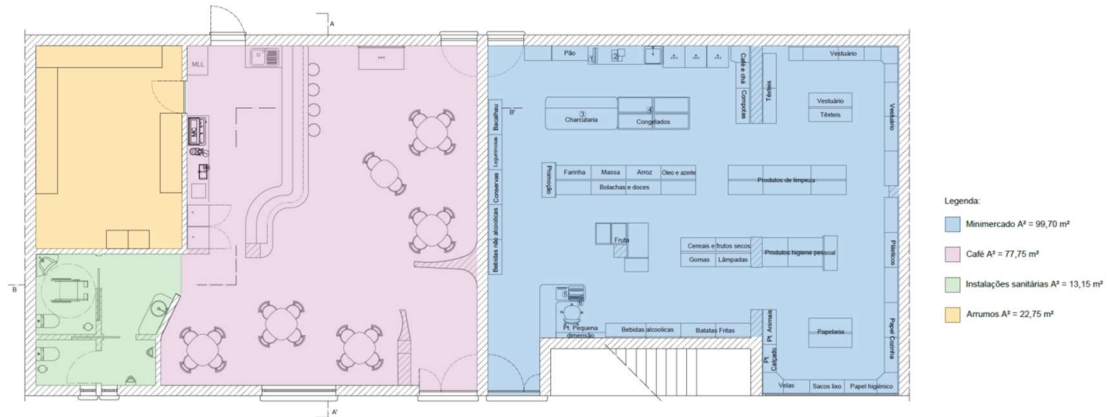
Planta de zonamento, Fonte: Autora, 2025
